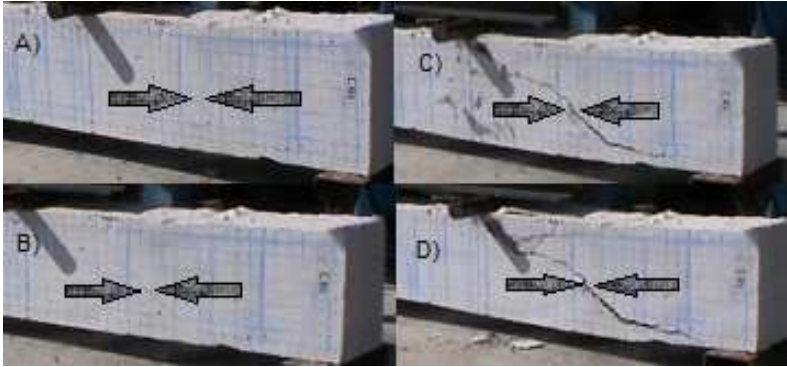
Patrón de grietas de la viga CR1.
